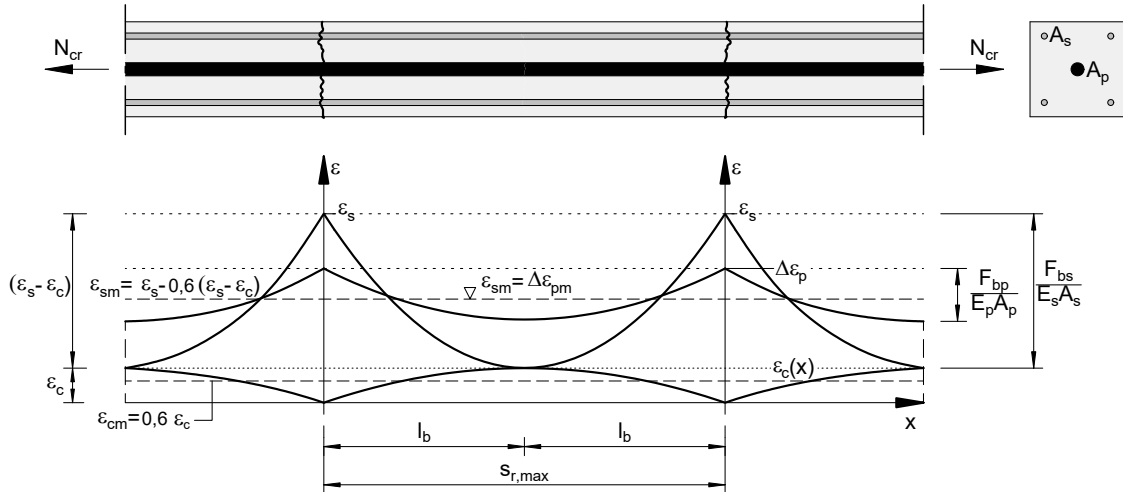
Verlauf der Dehnungen in Spannstahl, Betonstahl und Beton für die abgeschlossene Rissbildung
